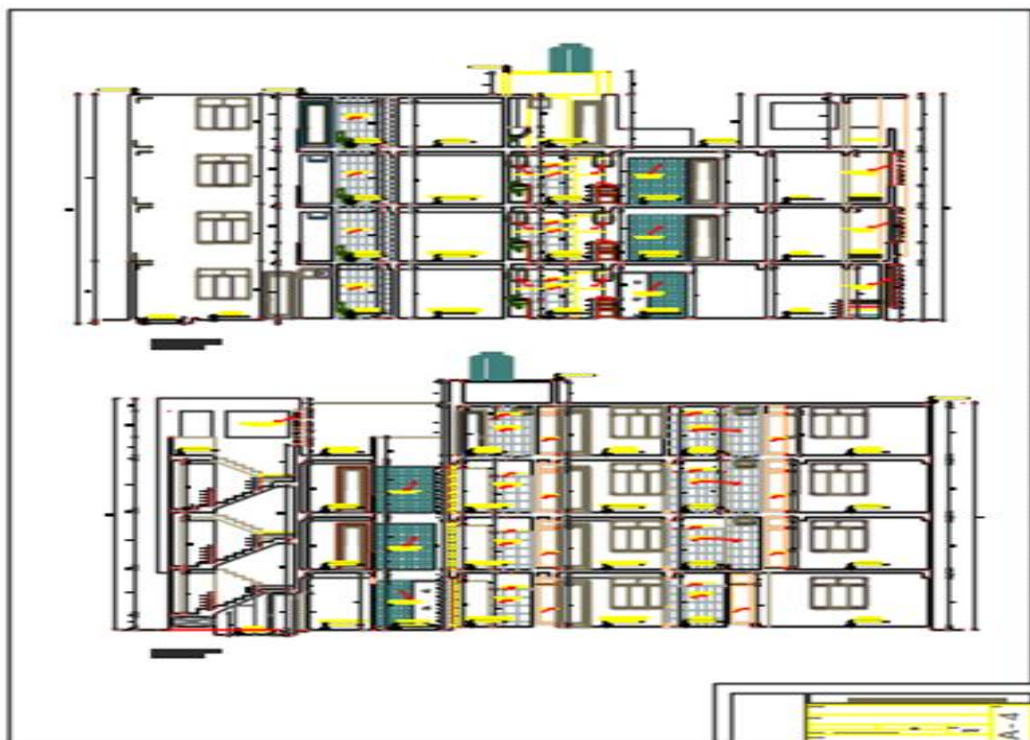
Lamina A-4 Arquitectura – Elevaciones
